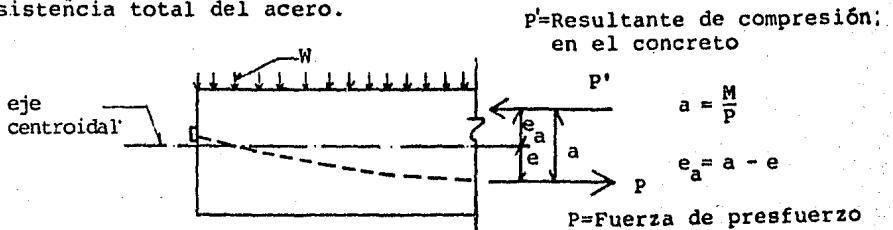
Momento interno resistente en vigas de concreto presforzado.
